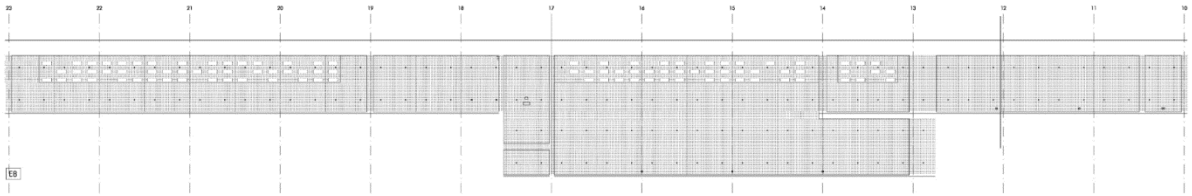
façades de musée de Madinat al-Zahra (archdaily.com).
